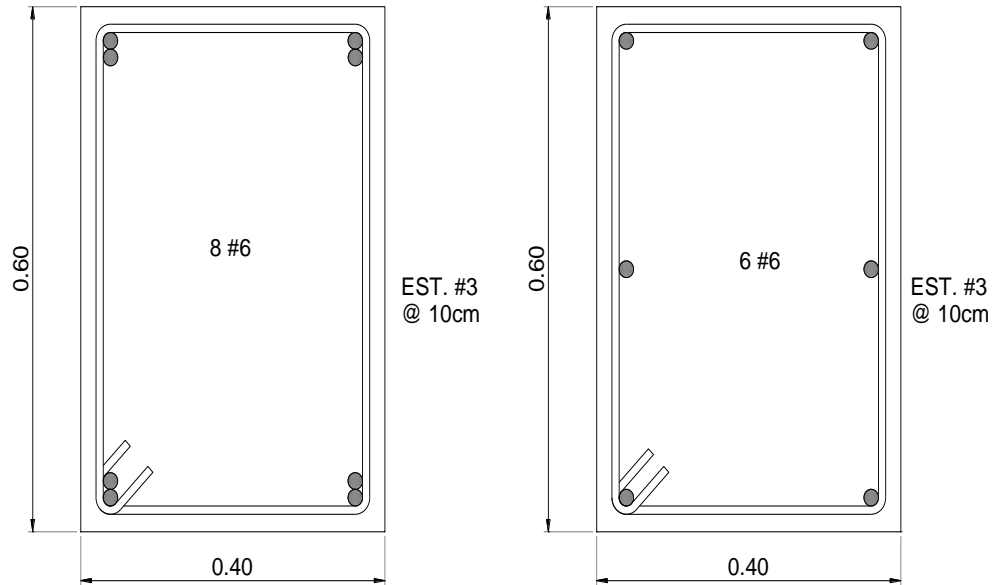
Armado de Columnas; izquierda columnas perimetrales, derecha columnas centrales, para el edificio de siete niveles en su primera etapa de construcción
